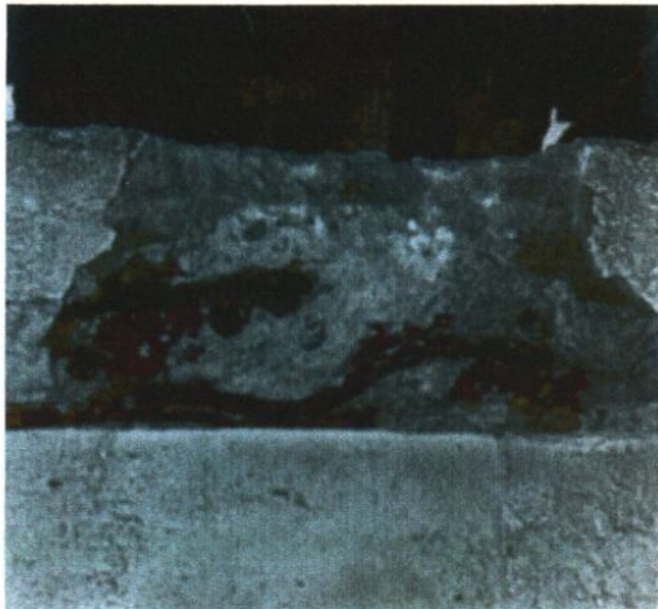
b. Armătură corodată în fisura din foto II.3.a și în afara acesteia
